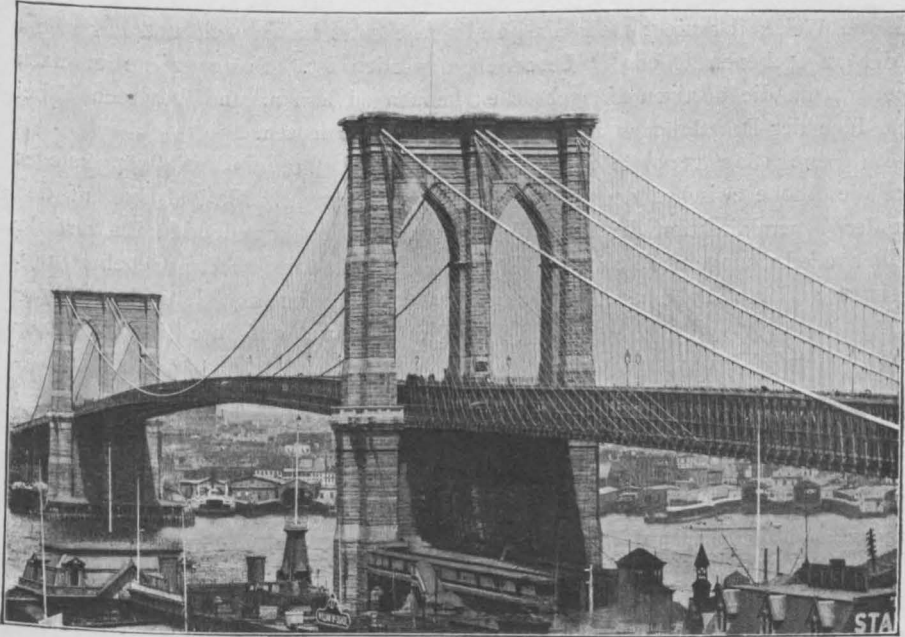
Alte Eastriverbrücke in New York. RÖBLING. 1870—1876.
